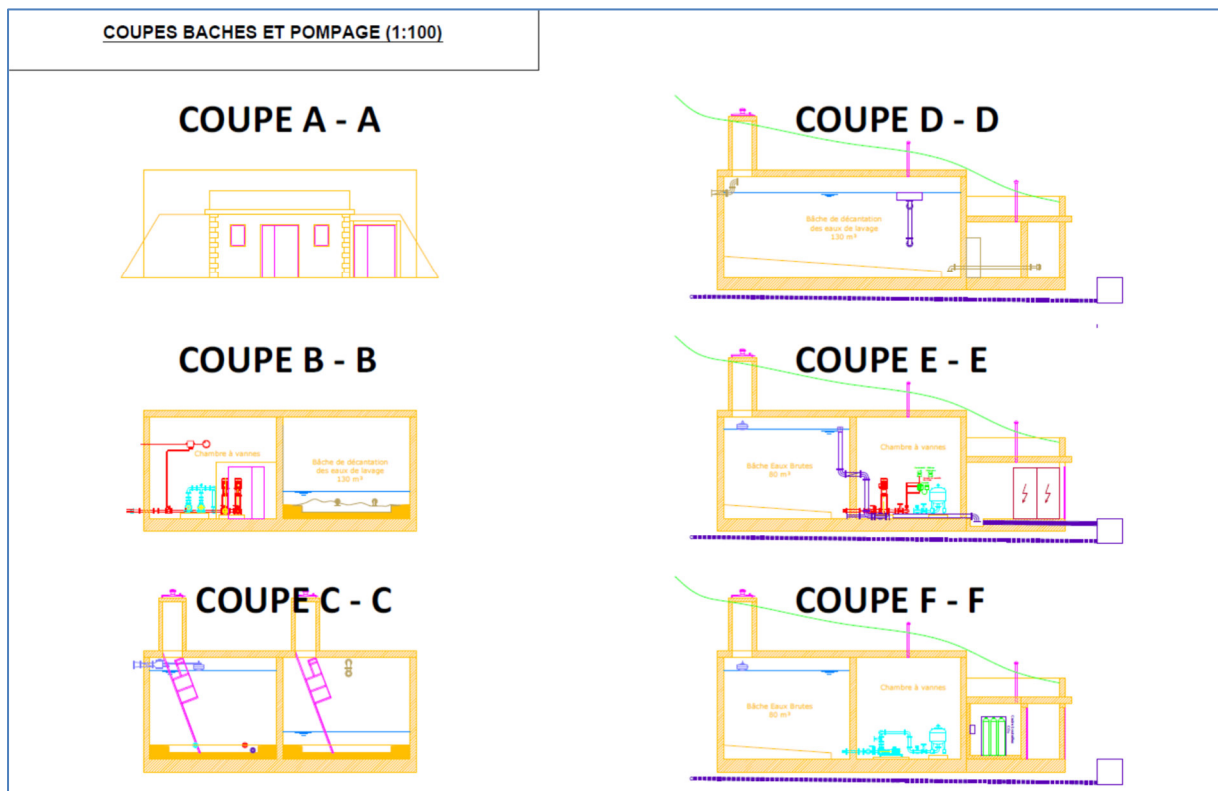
Plan de la bache eaux brutes et du local de pompage (vues en coupe)
